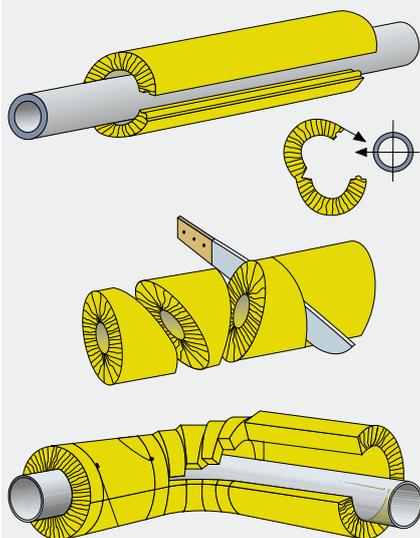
Монтаж цилиндра на прямом отрезке трубопровода
